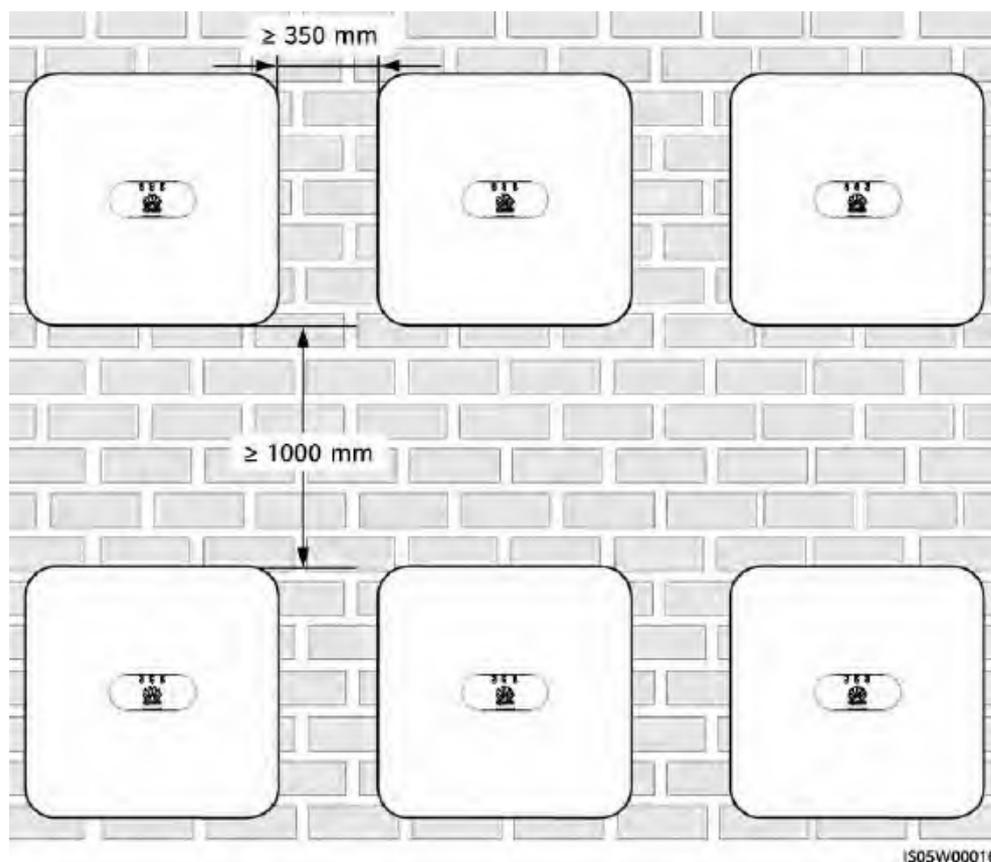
Монтаж друг над другом (не рекомендуется)
